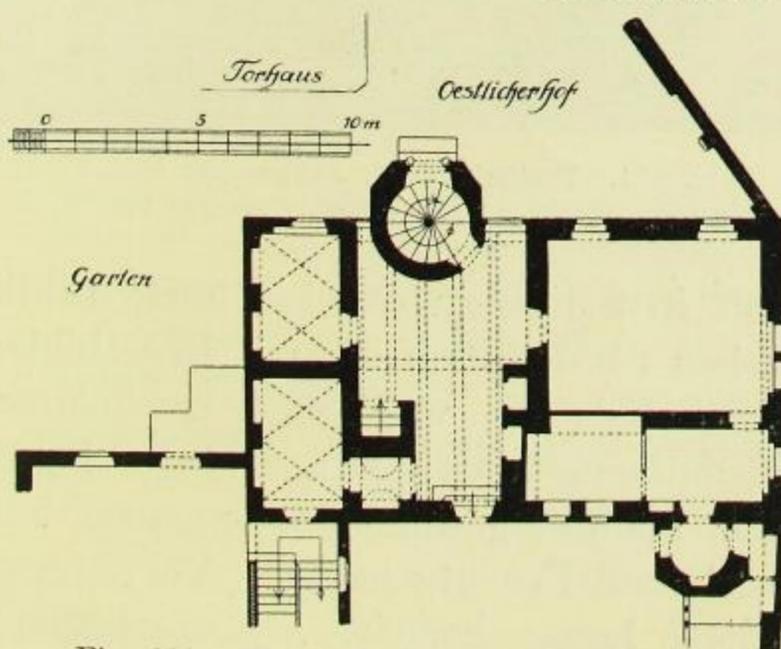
Freiheit Nr. 1, Hauptgebäude, Grundriß des Erdgeschosses.
